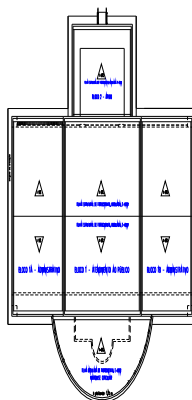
Correspondência entre planta de cobertura e projeto estrutural
